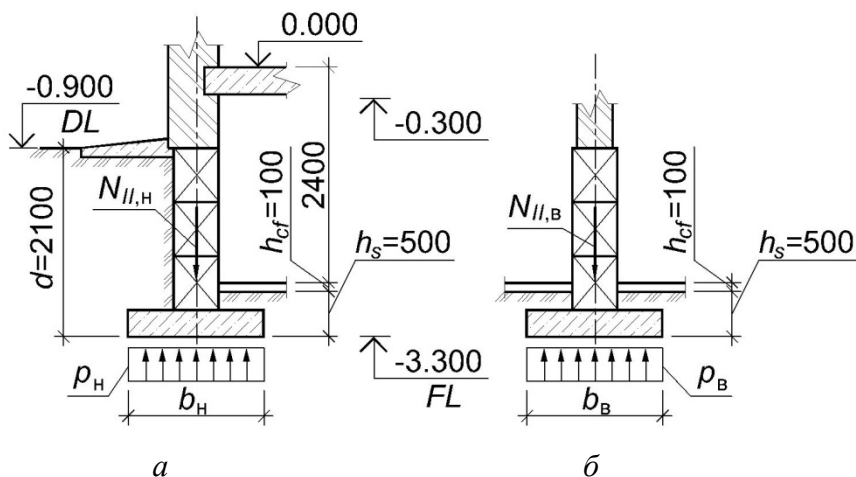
Схема к определению размеров подошвы ленточных фундаментов гражданского здания (пример 4.3):
